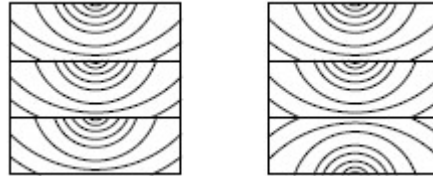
Sección transversal de las piezas de madera encolada laminada.
